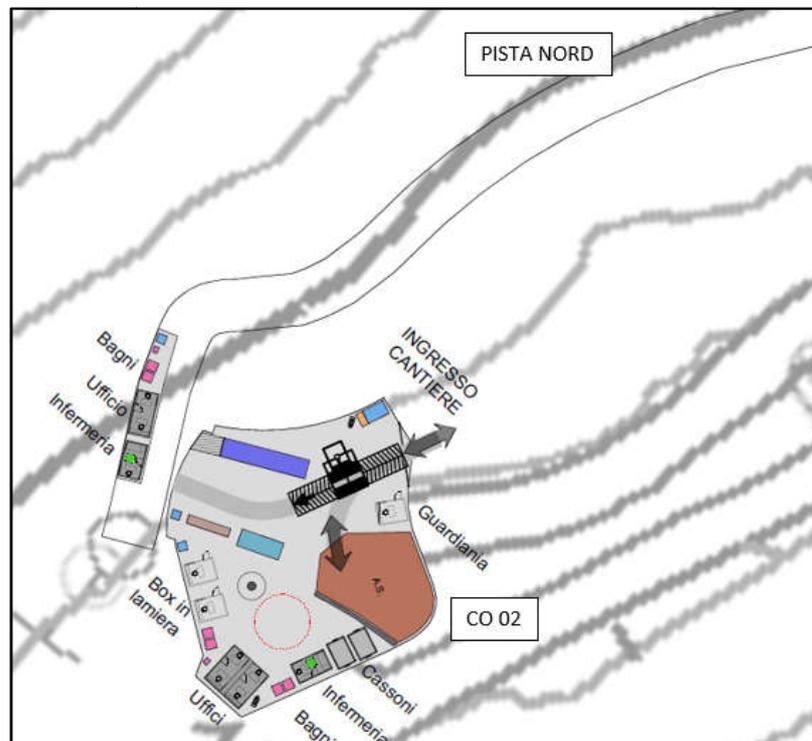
Layout cantiere operativo all'imbocco nord (Pista nord e CO 02) – (vista ruotata)
